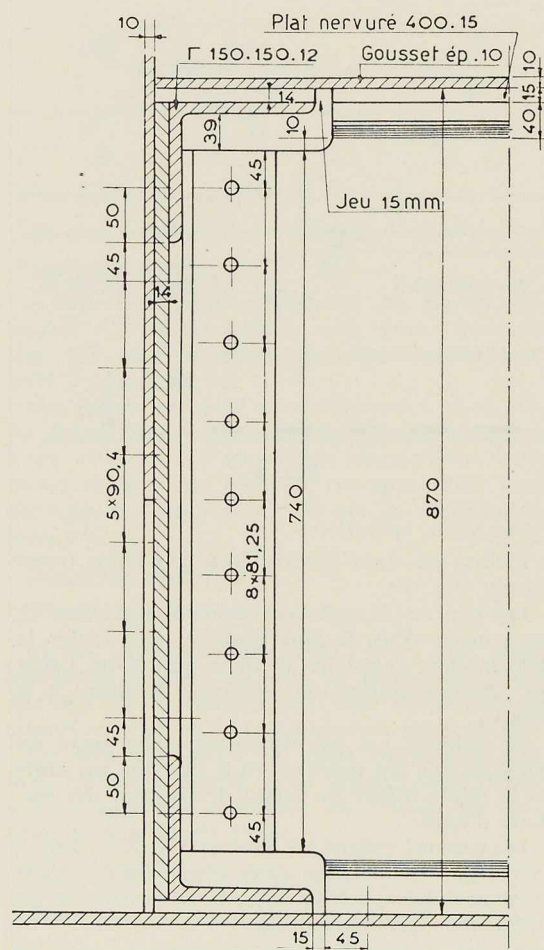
Assemblage d'une entretoise à une maitresse-poutre.
